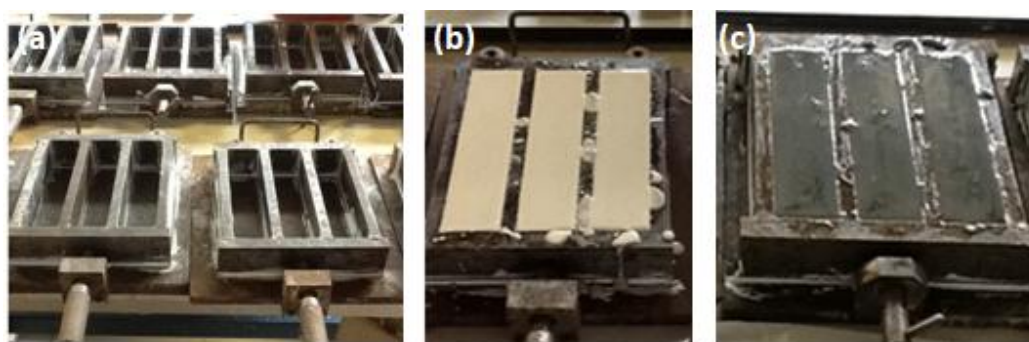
Moldes para a realização dos provetes *standard*: (a) Preparação dos moldes; (b) Moldes com *grout* de referência; (c) Moldes com *grout* à base de geopolímero
